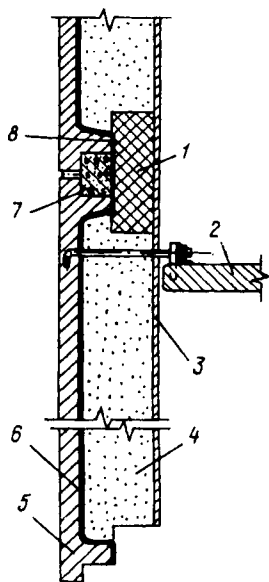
Изоляция стены многоэтажного холодильника сборными панелями (горизонтальный шов):
